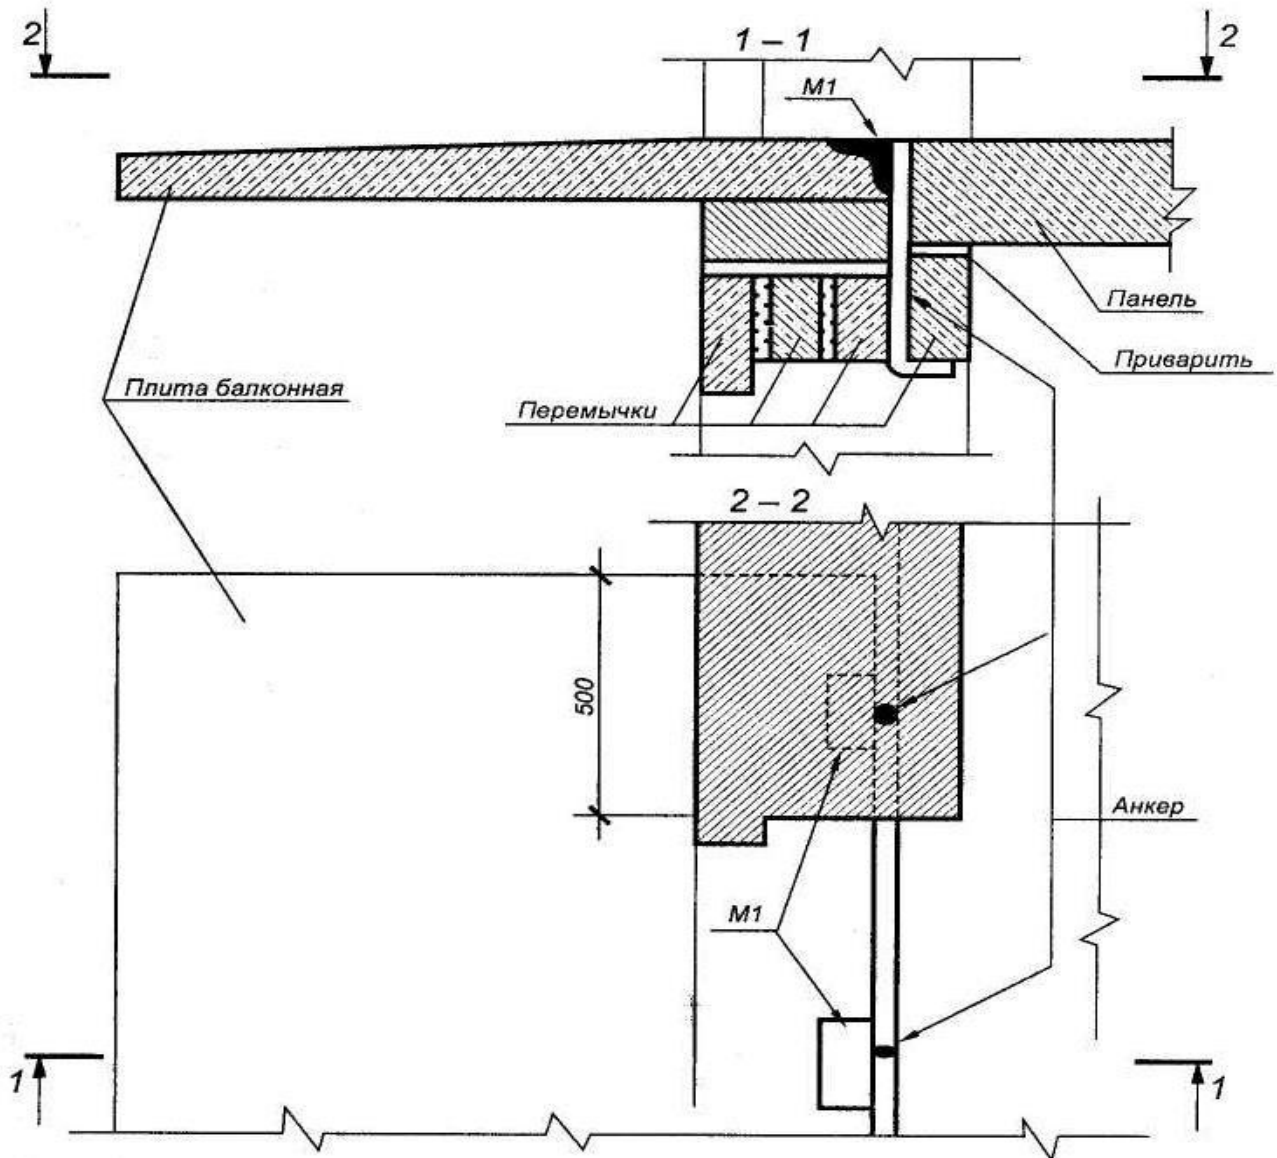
Крепление балконной плиты в стене кирпичной кладки
